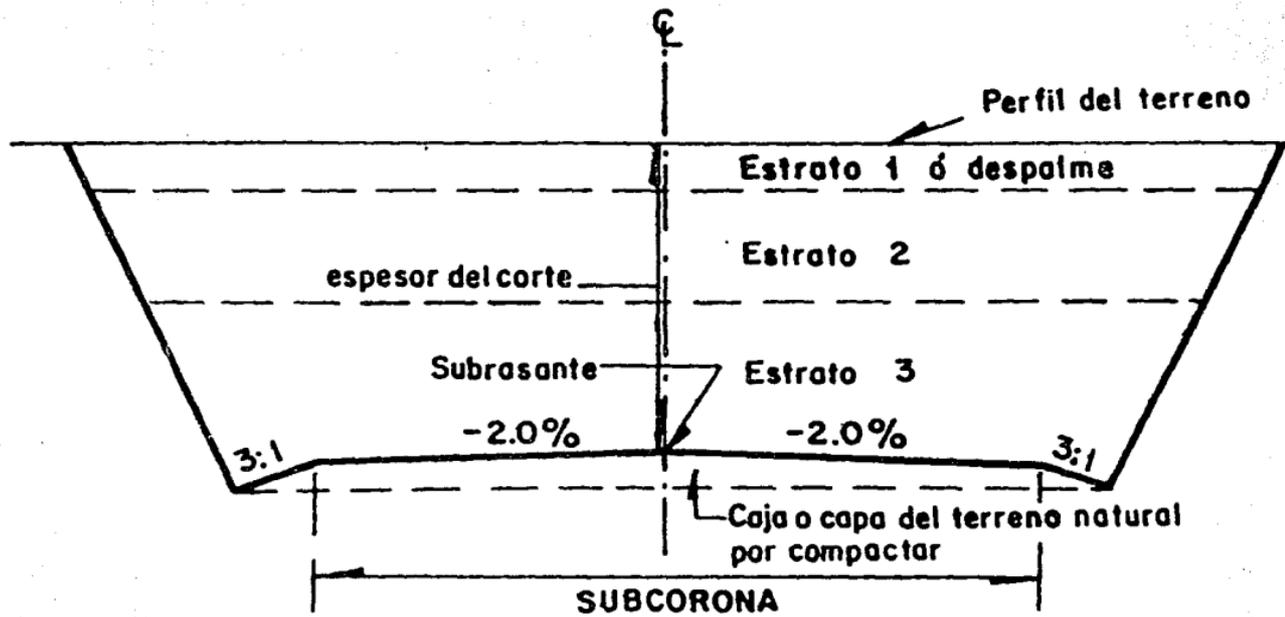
SECCION DE CONSTRUCCION DE UN CORTE EN TANGENTE
